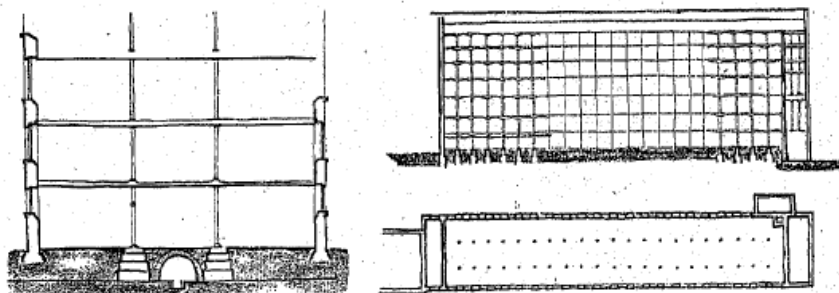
Planta y secciones de Boulton y Watt, Salford (1801).<sup>23</sup>
